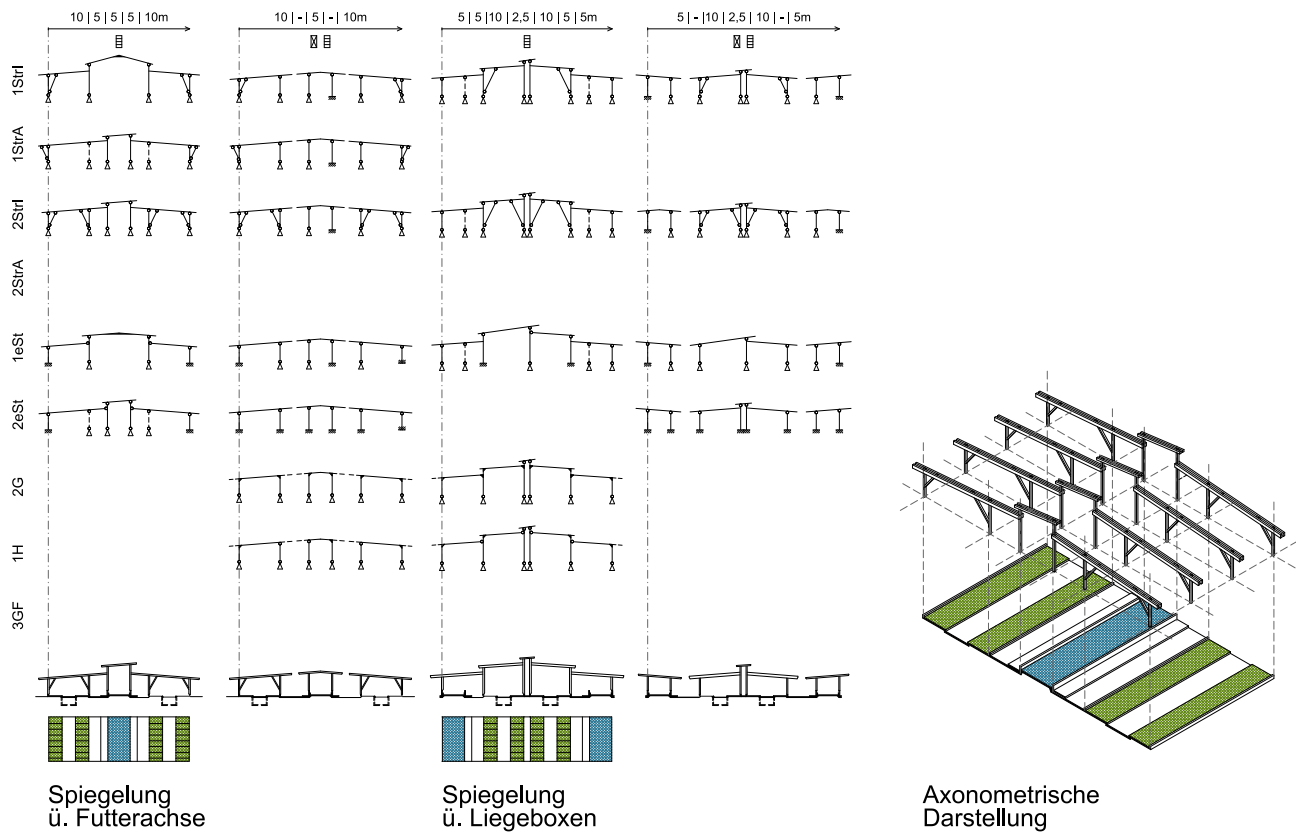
Ausschnitt aus einer Seite des Typenkatalogs mit Abstimmung zwischen Grundrissen (hier Erweiterungen) und Tragwerksvarianten, axonometrische Darstellung.
